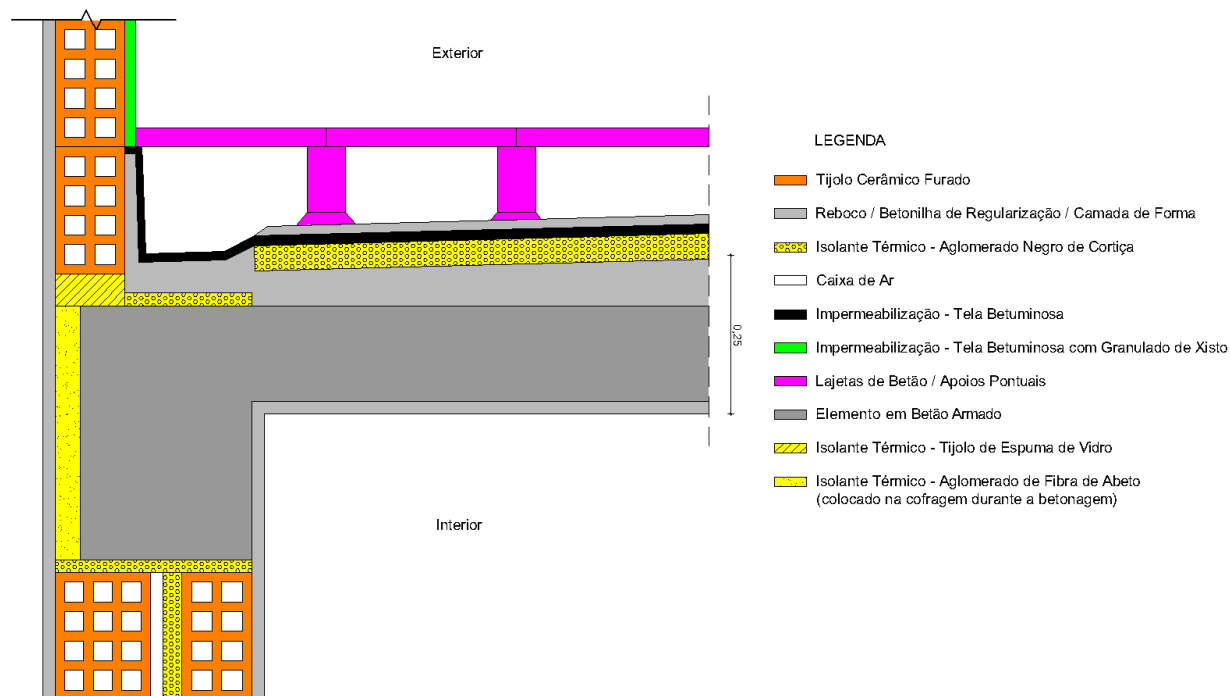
Ligação da fachada com cobertura plana visitável, adaptado de [10]
